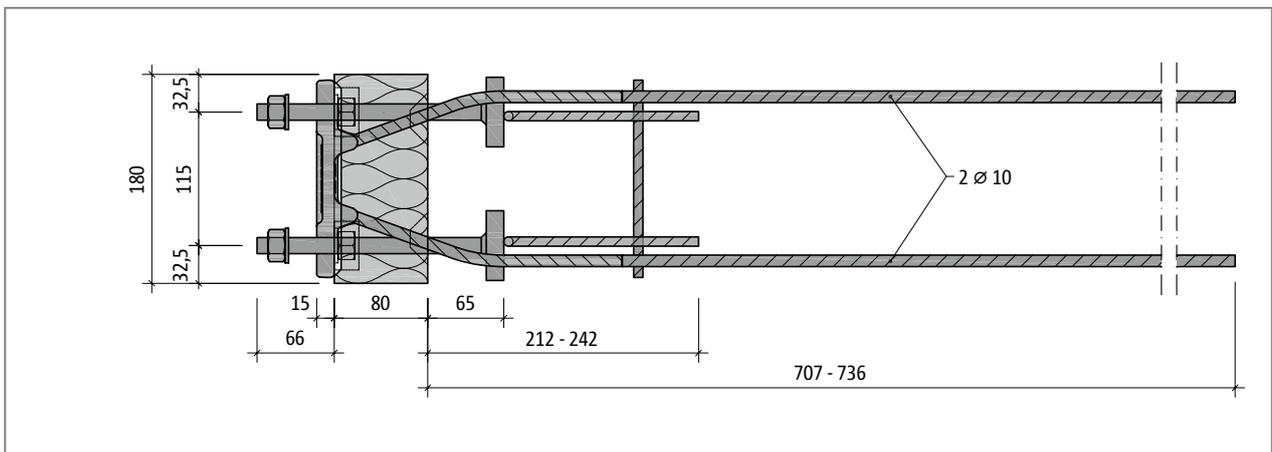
Schöck Isokorb® T type SQ-V2 : plan de base
